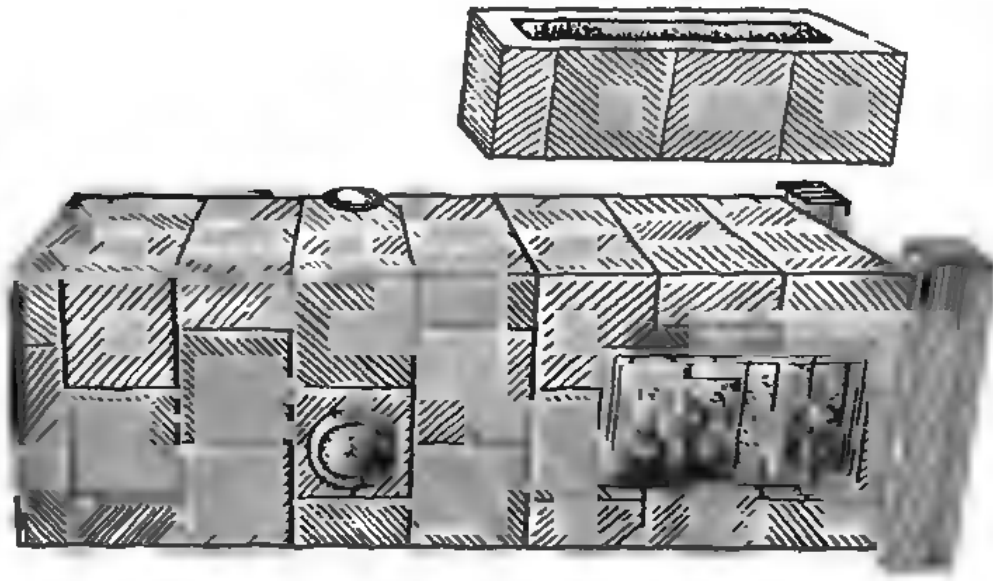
Общий вид сборно-блочной печи МВМС-306
